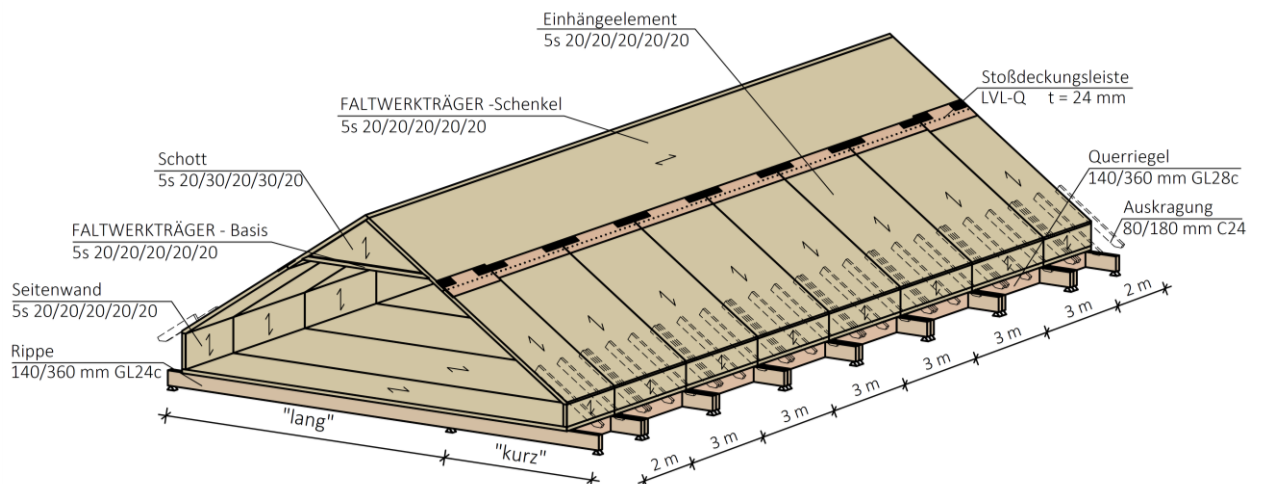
Bauteilabmessungen „Falterk“-Konstruktion
